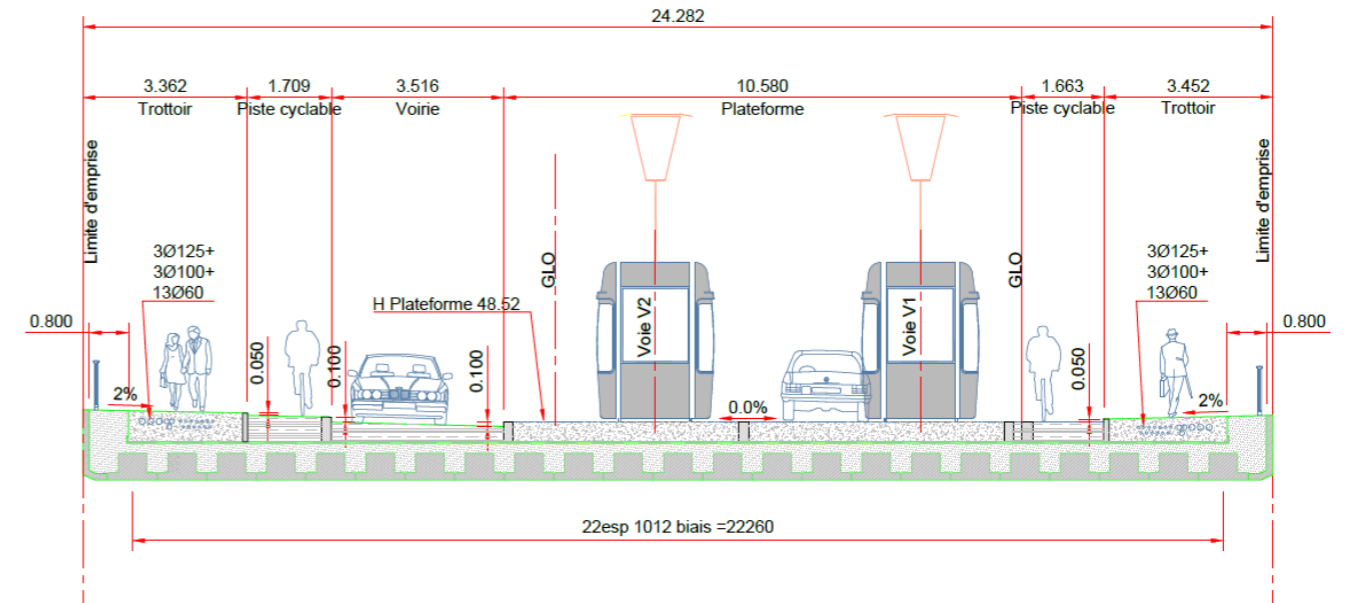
coupe transversale fonctionnelle sur ouvrage
